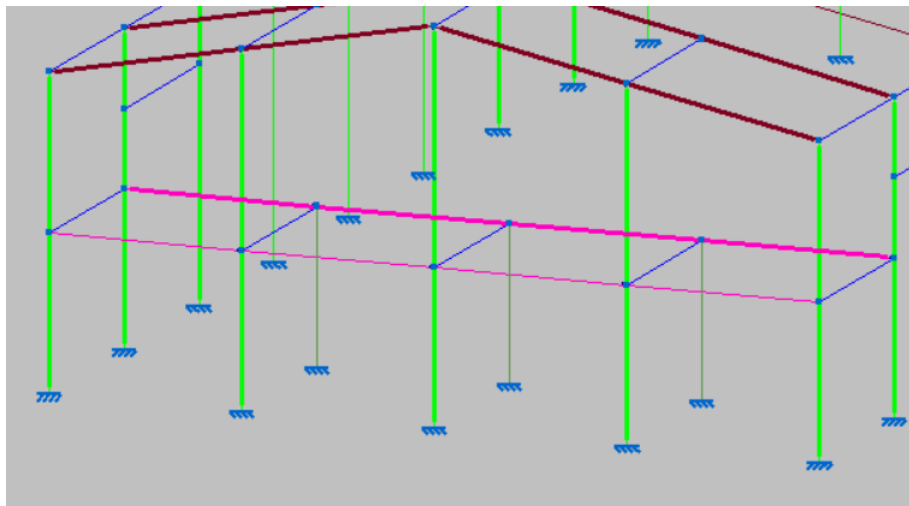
Pilarillos, pilares interiores y vigas del forjado
